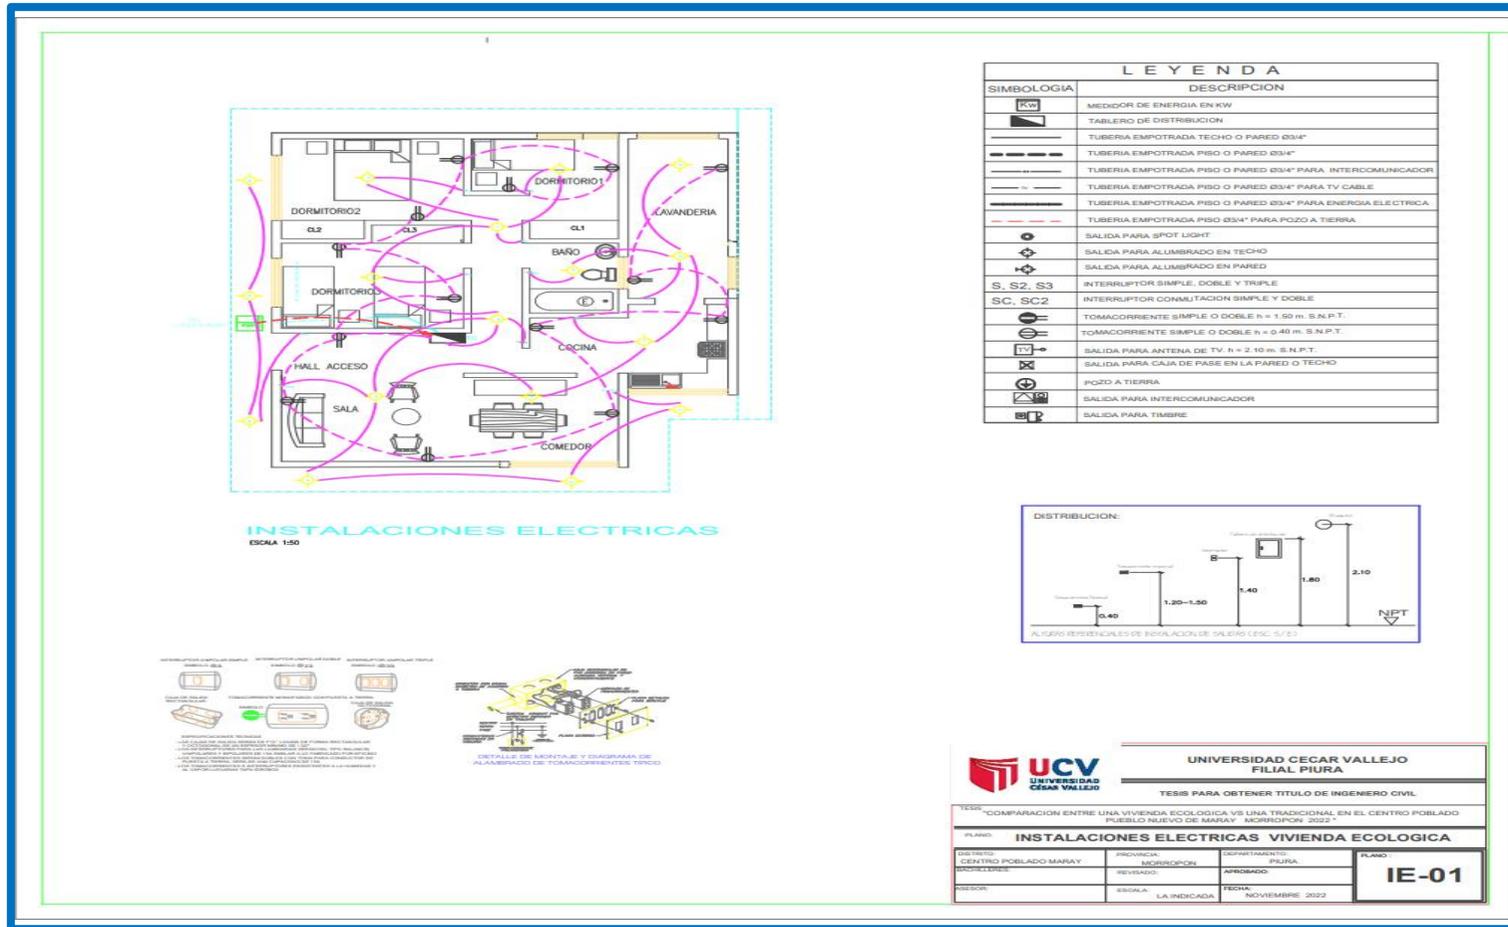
Plano de instalaciones eléctricas – vivienda ecológica (IE – 01)
